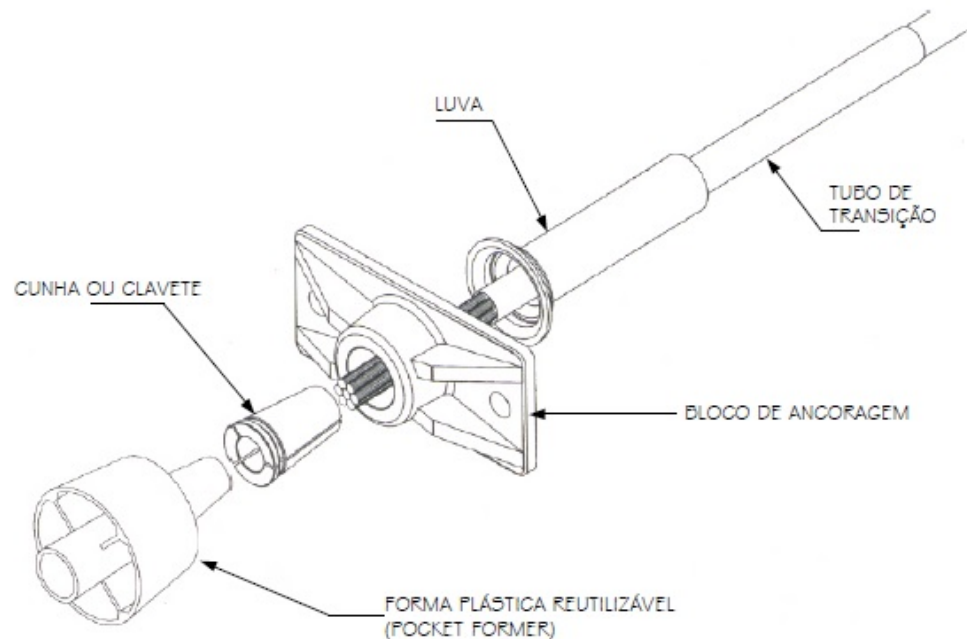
Detalhamento Prático de Ancoragem. (Projeto e execução de Lajes Protendidas, 2005. EMERICK, Alexandre A.)
